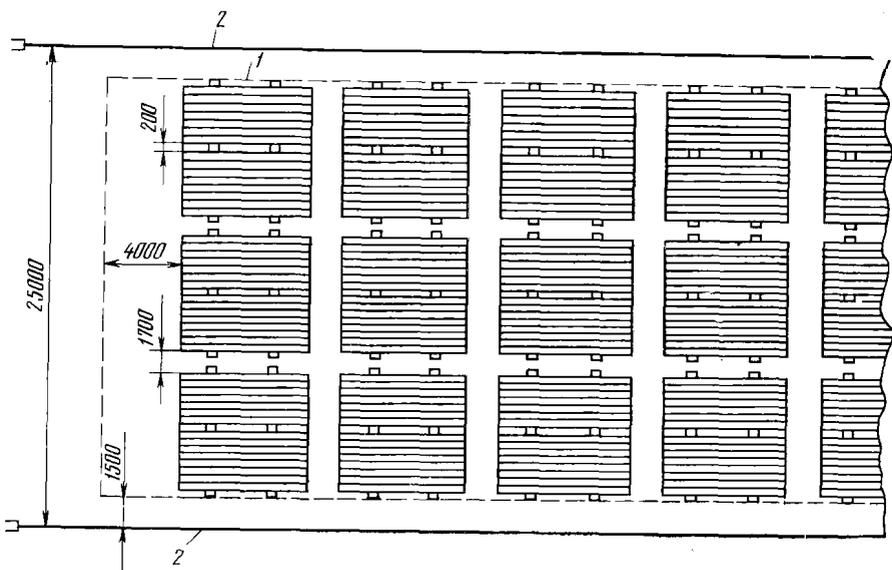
Схема укладки пакетов с лесоматериалами на площадке, оборудованной двухконсольным козловым краном с пролетом 25 м:
